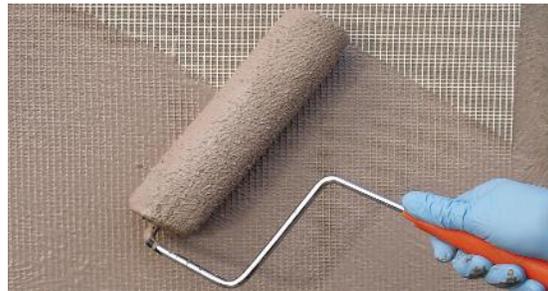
Protección con Mapelastic de una fisura en el intradós de una viga de hormigón sometida a una tensión por flexión
